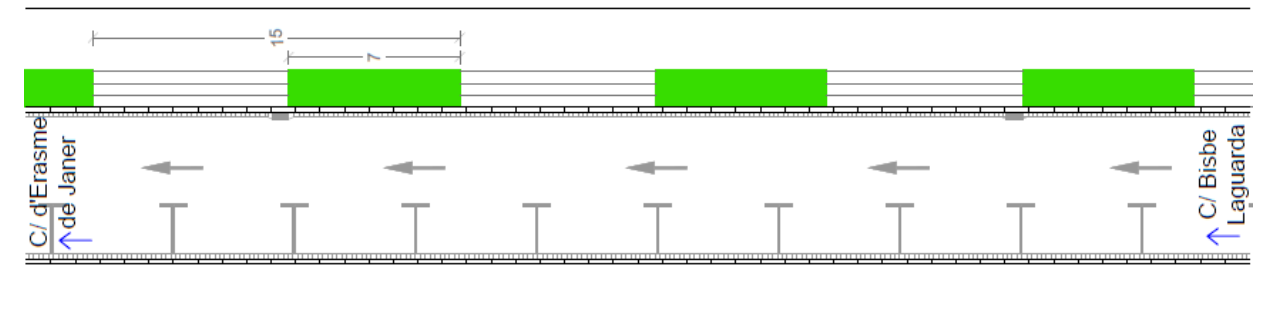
Planta de la propuesta para la C/ Riera Alta, caso a) (Tipo 2).
